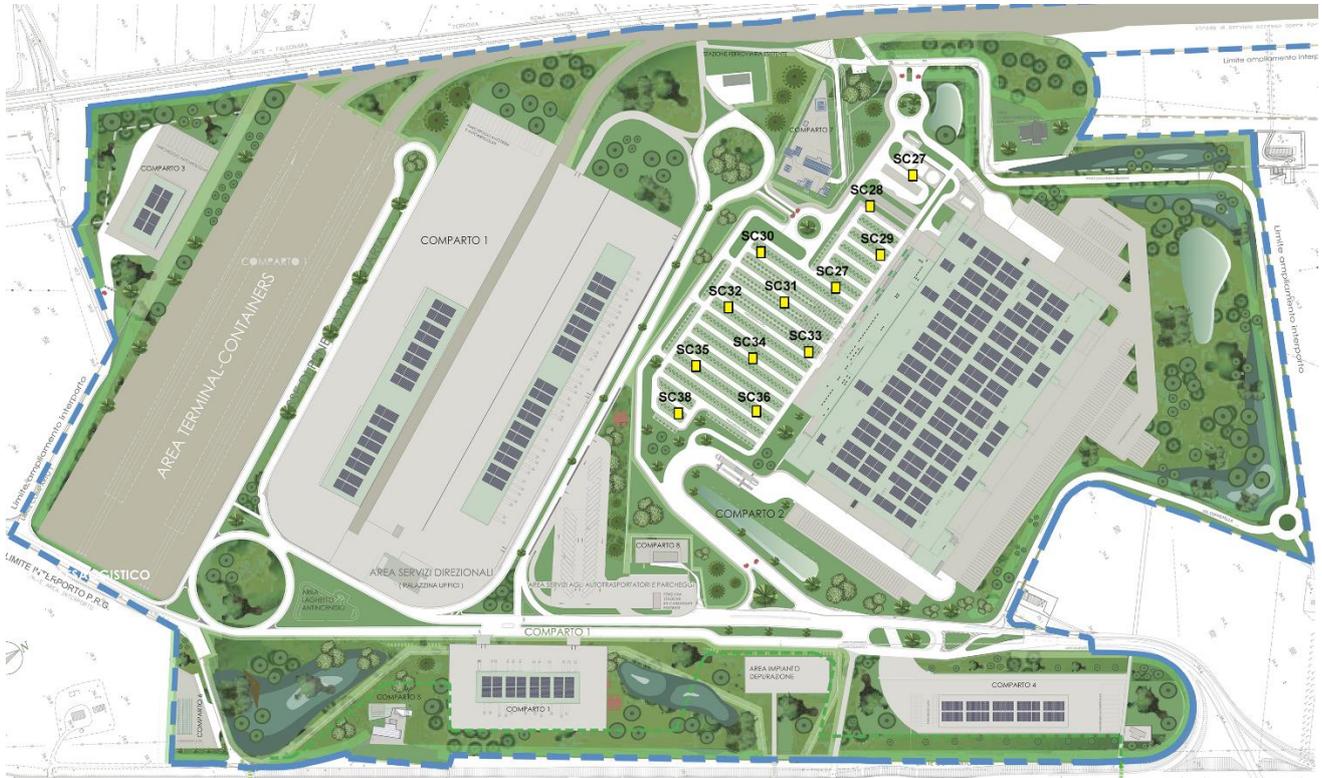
Planimetria con l'ubicazione dei campionamenti nell'area adibita a parcheggio.
